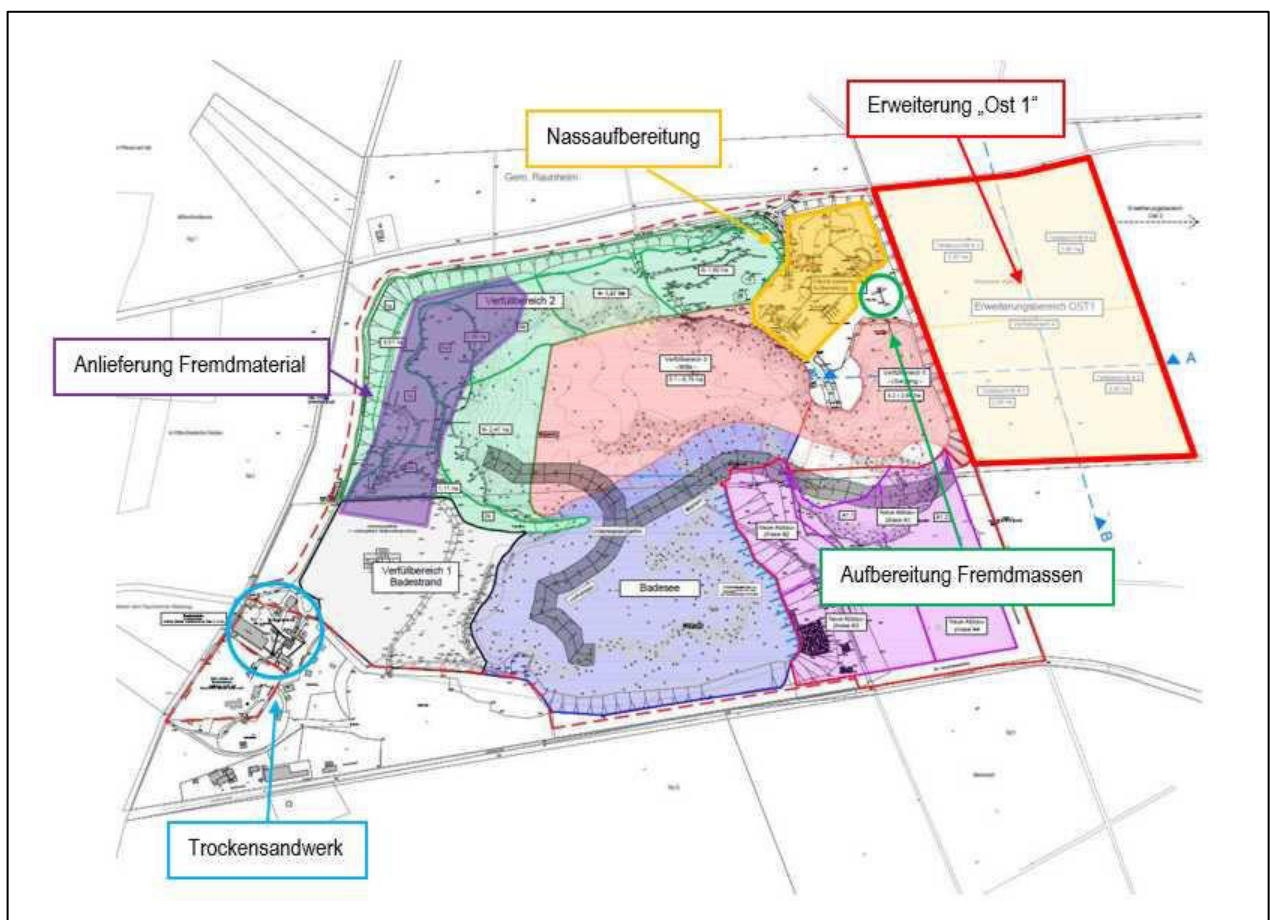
Lage des bestehenden Tagebaus mit der östlichen Erweiterungsfläche
